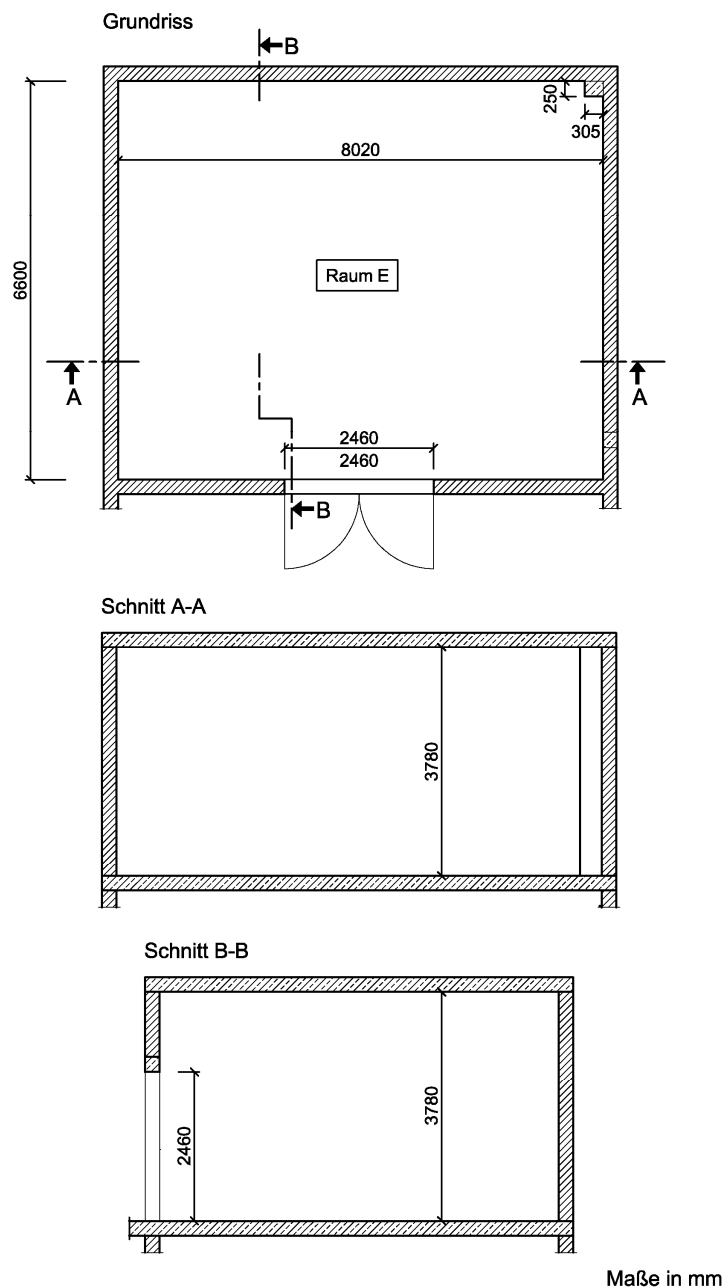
Grundriss und Schnitte des Hallraums.
